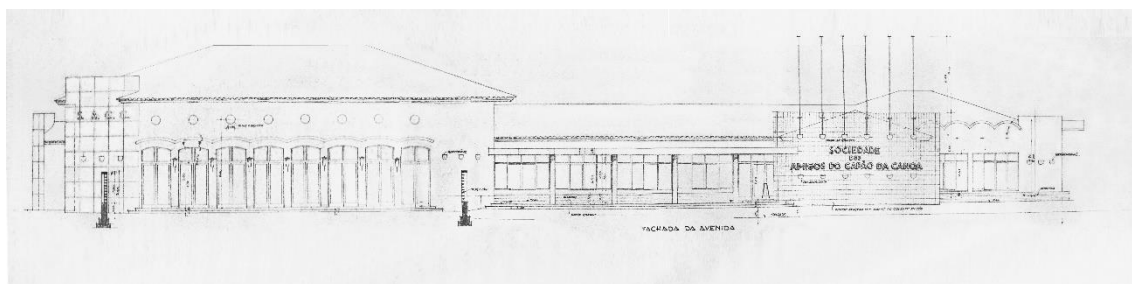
Fachada da avenida Paraguassú - SACC, 1959.
